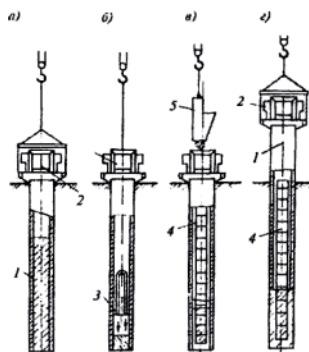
Технологическая схема изготовления набивных свай с выемкой грунта под защитой обсадных труб:
